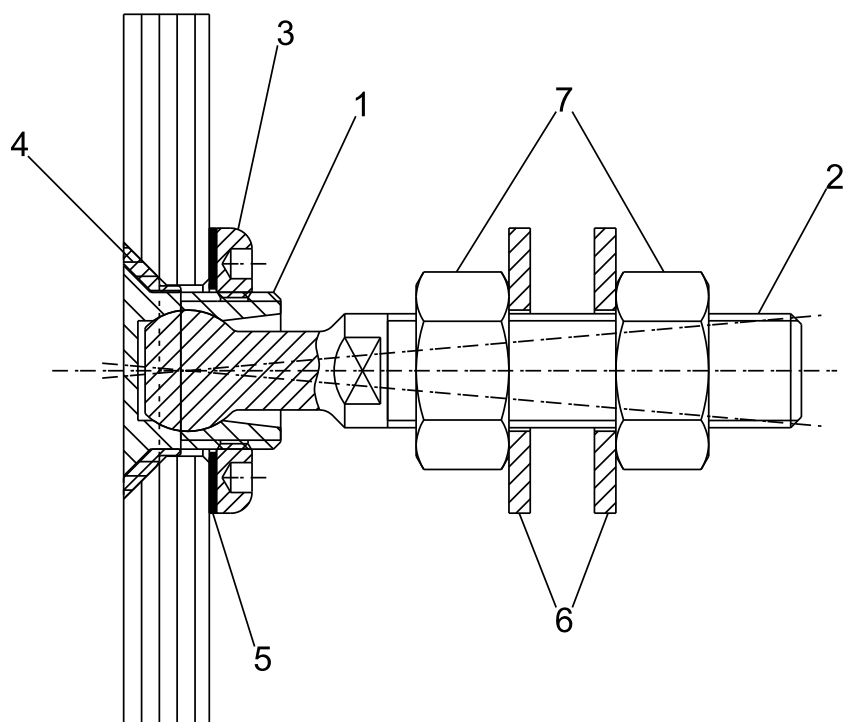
Coupe sur fixation traversante pour vitrage POINT type 36/24
